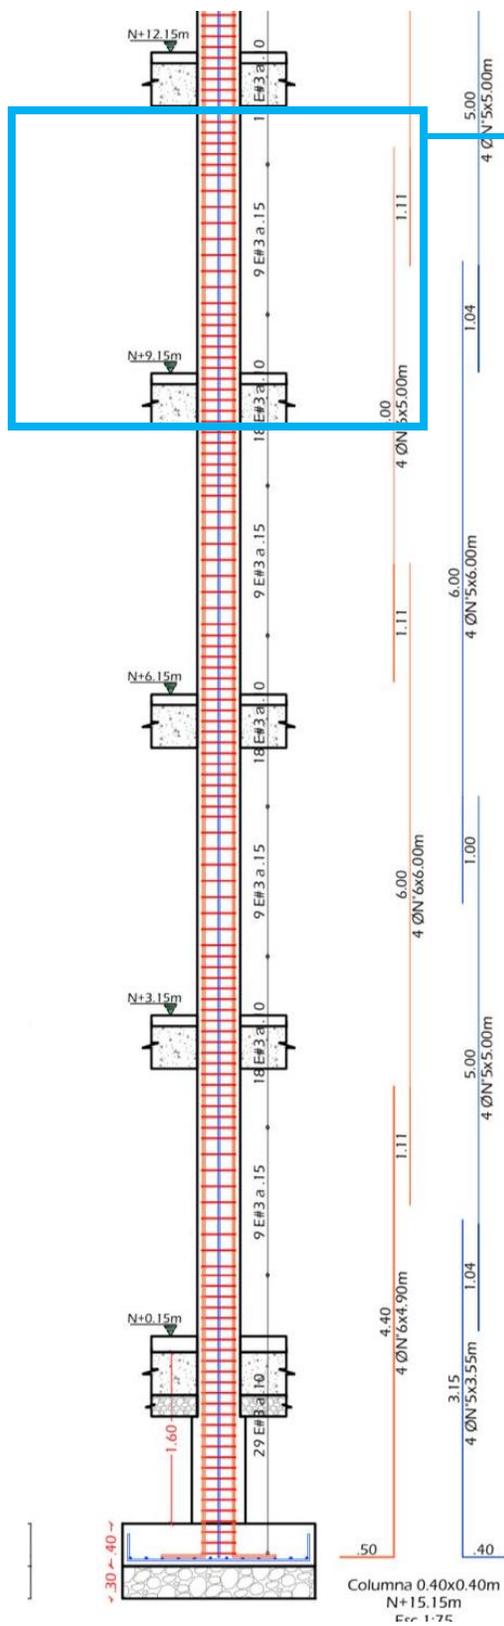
Despiece transversal y longitudinal de columna T1 plano Wiedii
